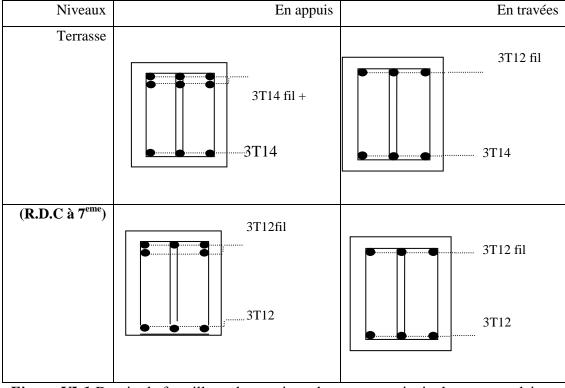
Dessin de ferraillage des sections des poutres principales et secondaires.
